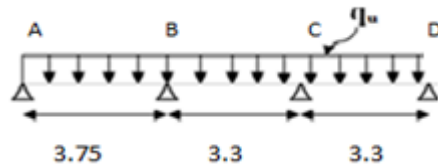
Schéma statique de la poutrelle a trois travées
